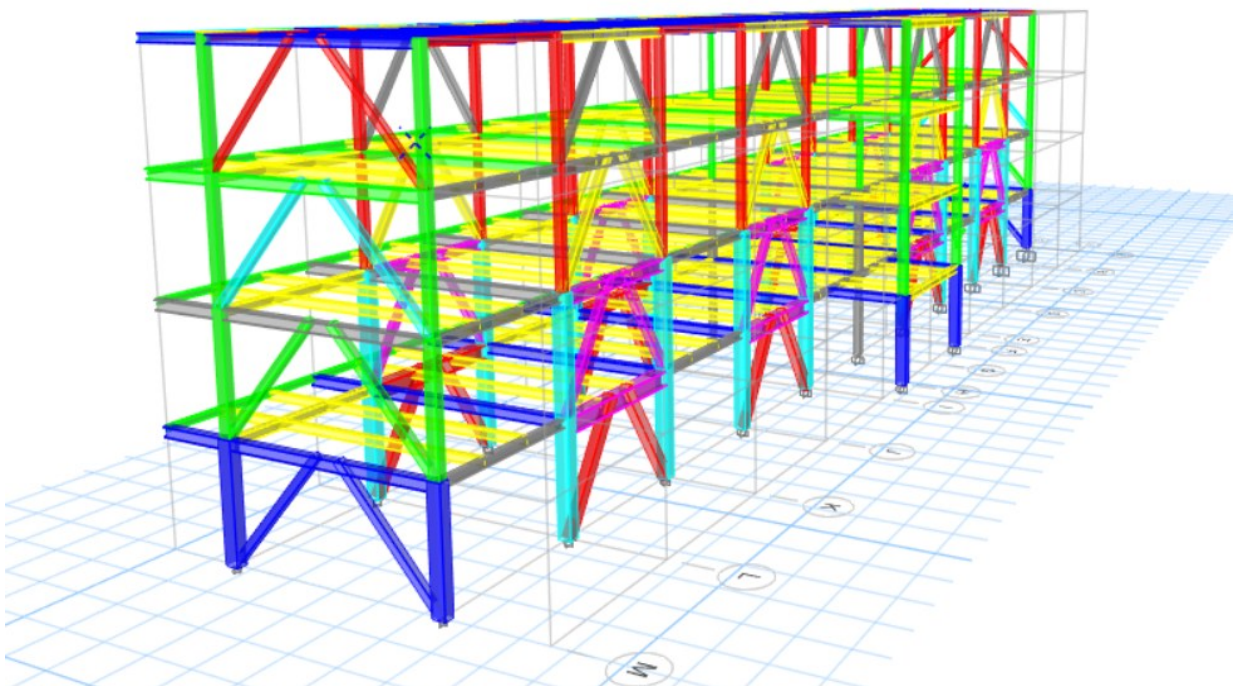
Modelo arquitectónico en planta con vigas secundaria.
